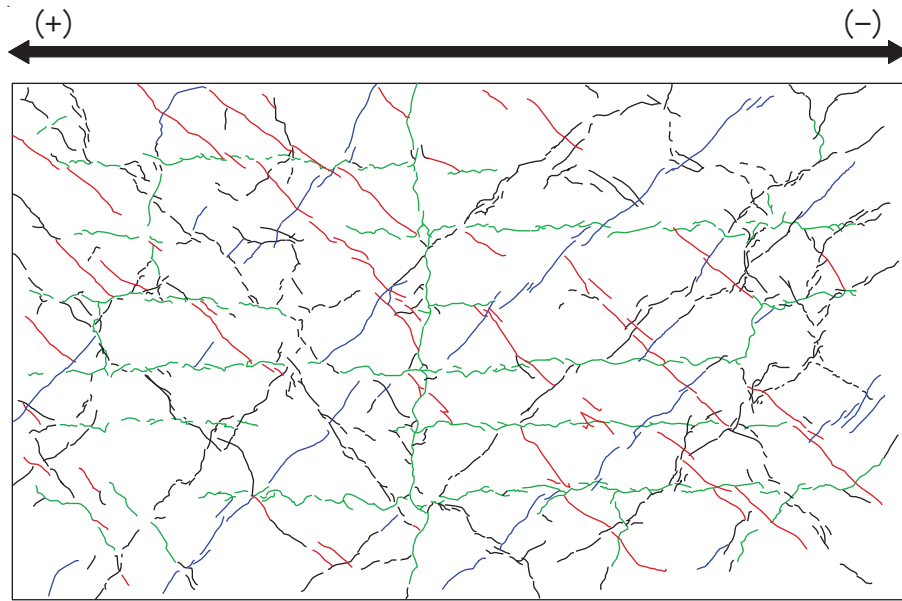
(9) 乾燥試験体 [1] 1/500rad. におけるひび割れ図
